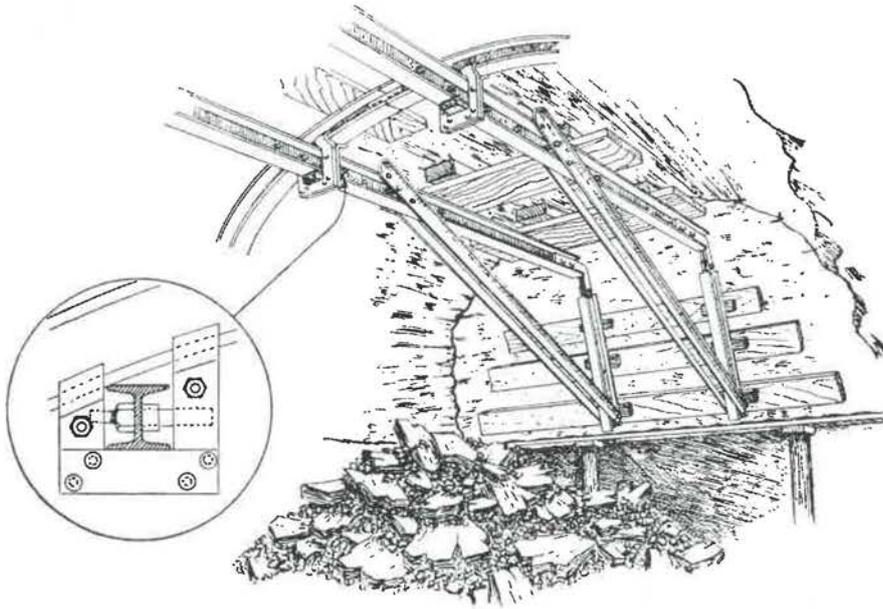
Soutènement du front par un assemblage fixé sur les poutrelles en porte-à-faux.
